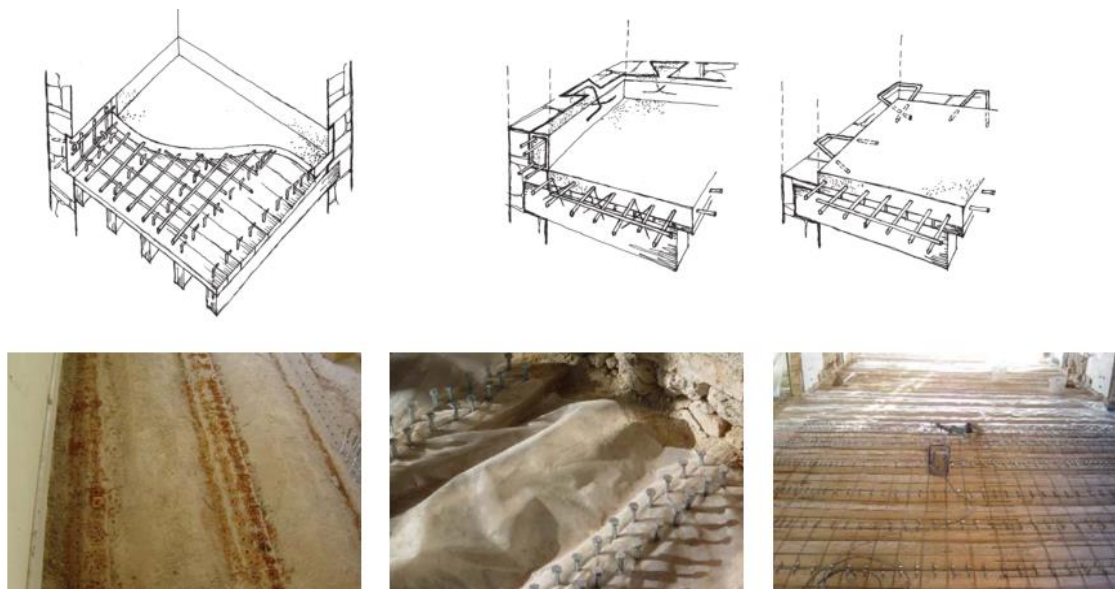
Exemplo de reforço de pavimentos através da construção de camadas de betão armado (“Herramienta 8,” n.d.)
